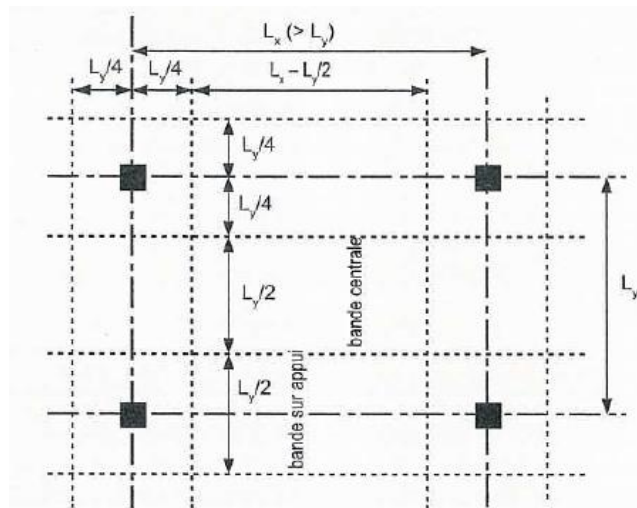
Planchers-dalles – Principe de découpage en bandes
